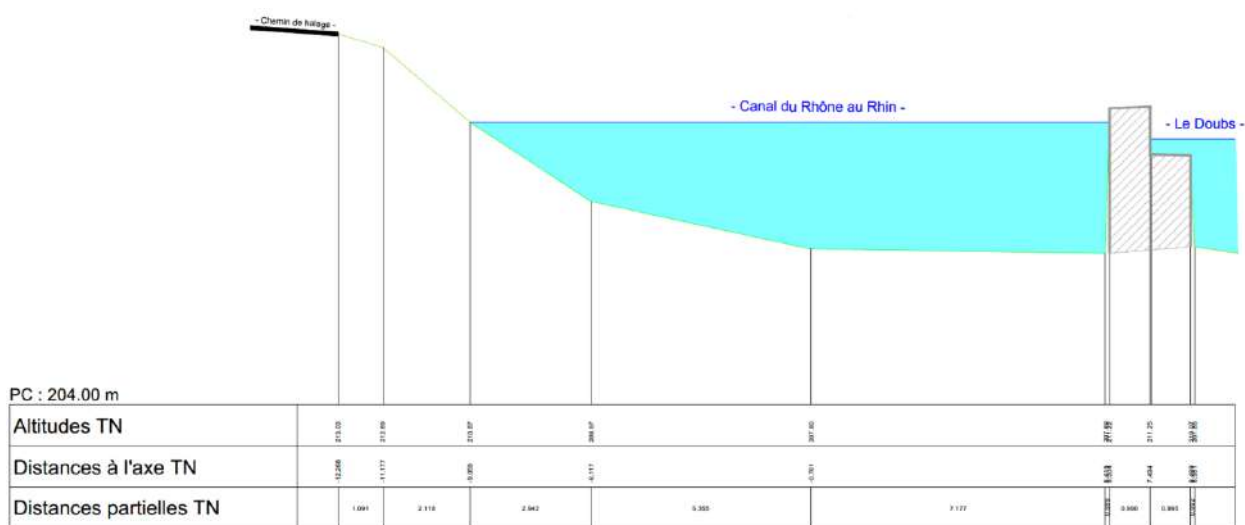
Coupe transversale de la berge en rive droite du bief 61/62
